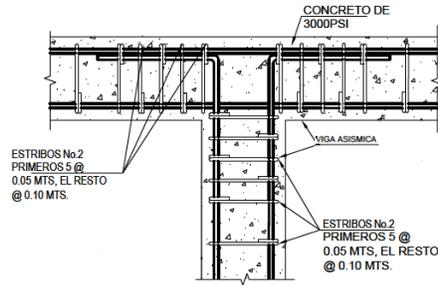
Detalle de traslape y anclaje de Viga asísmica, según planos
